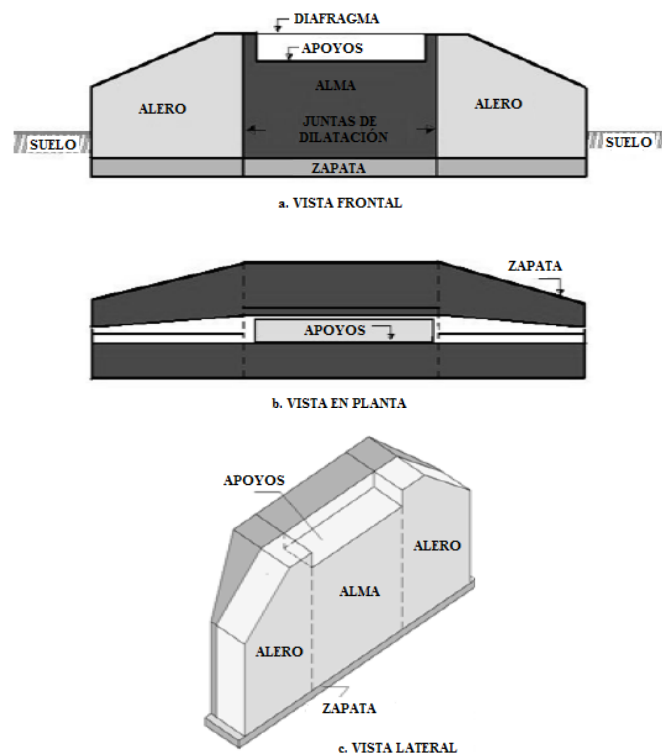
ESTRIBOS CON ALEROS EN LÍNEA RECTA.
